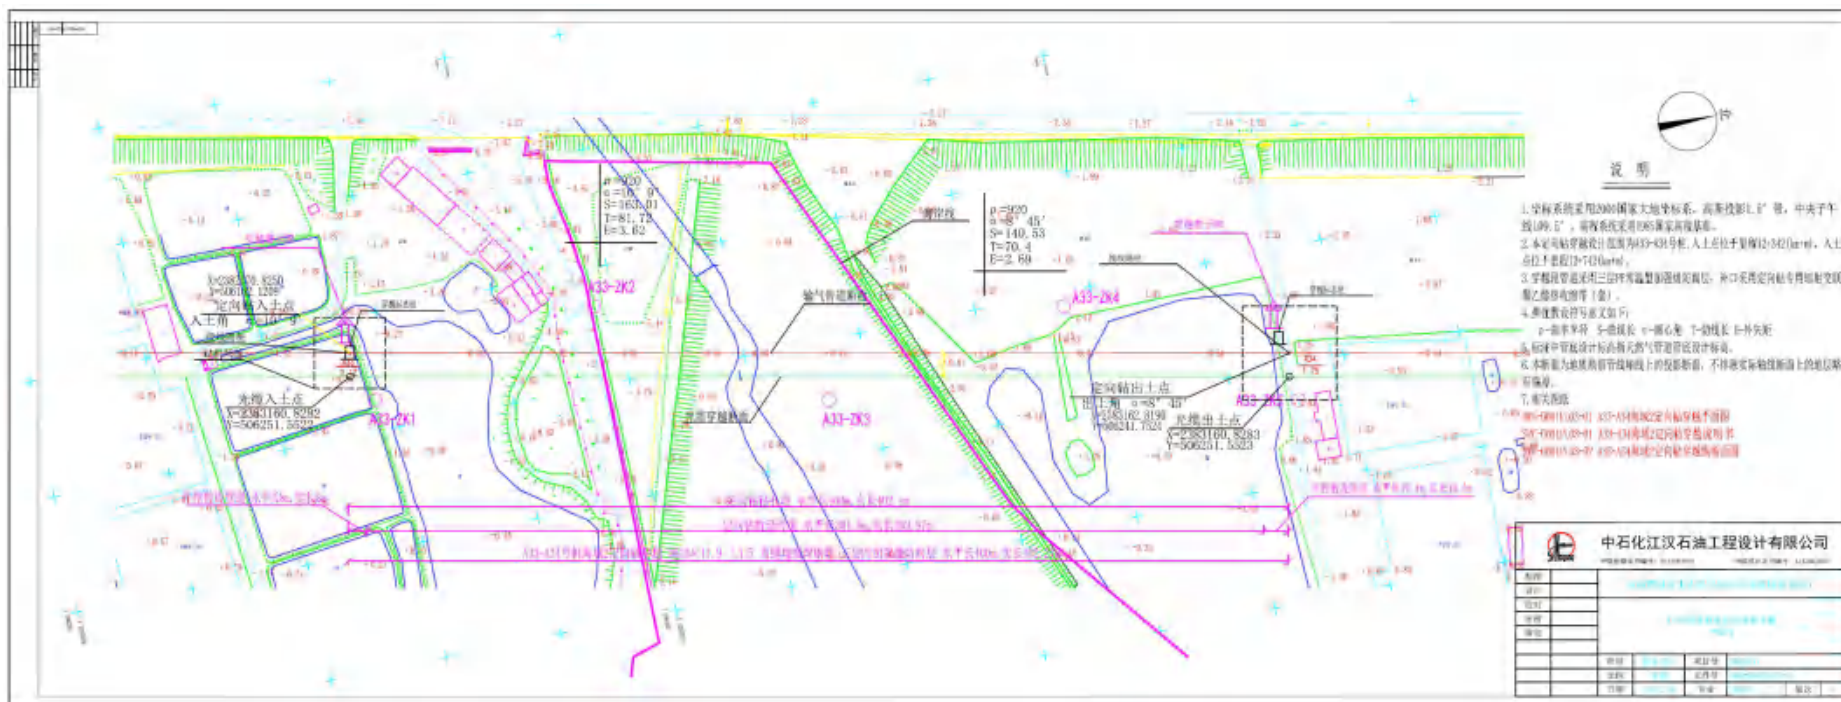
项目涉海段 2 管线定向钻穿越平面布置图
